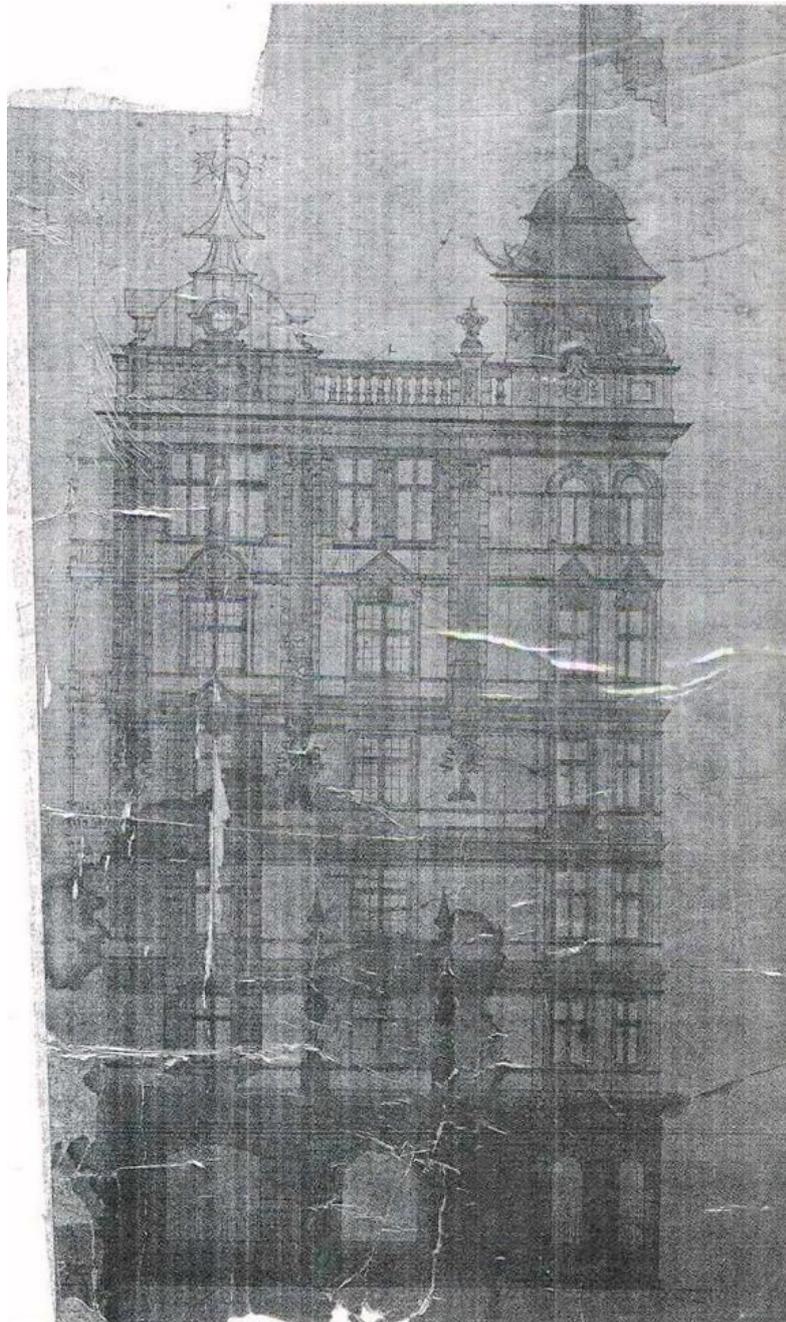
Diseño de la fachada principal del “Edificio Sur del Hotel Palacio”
